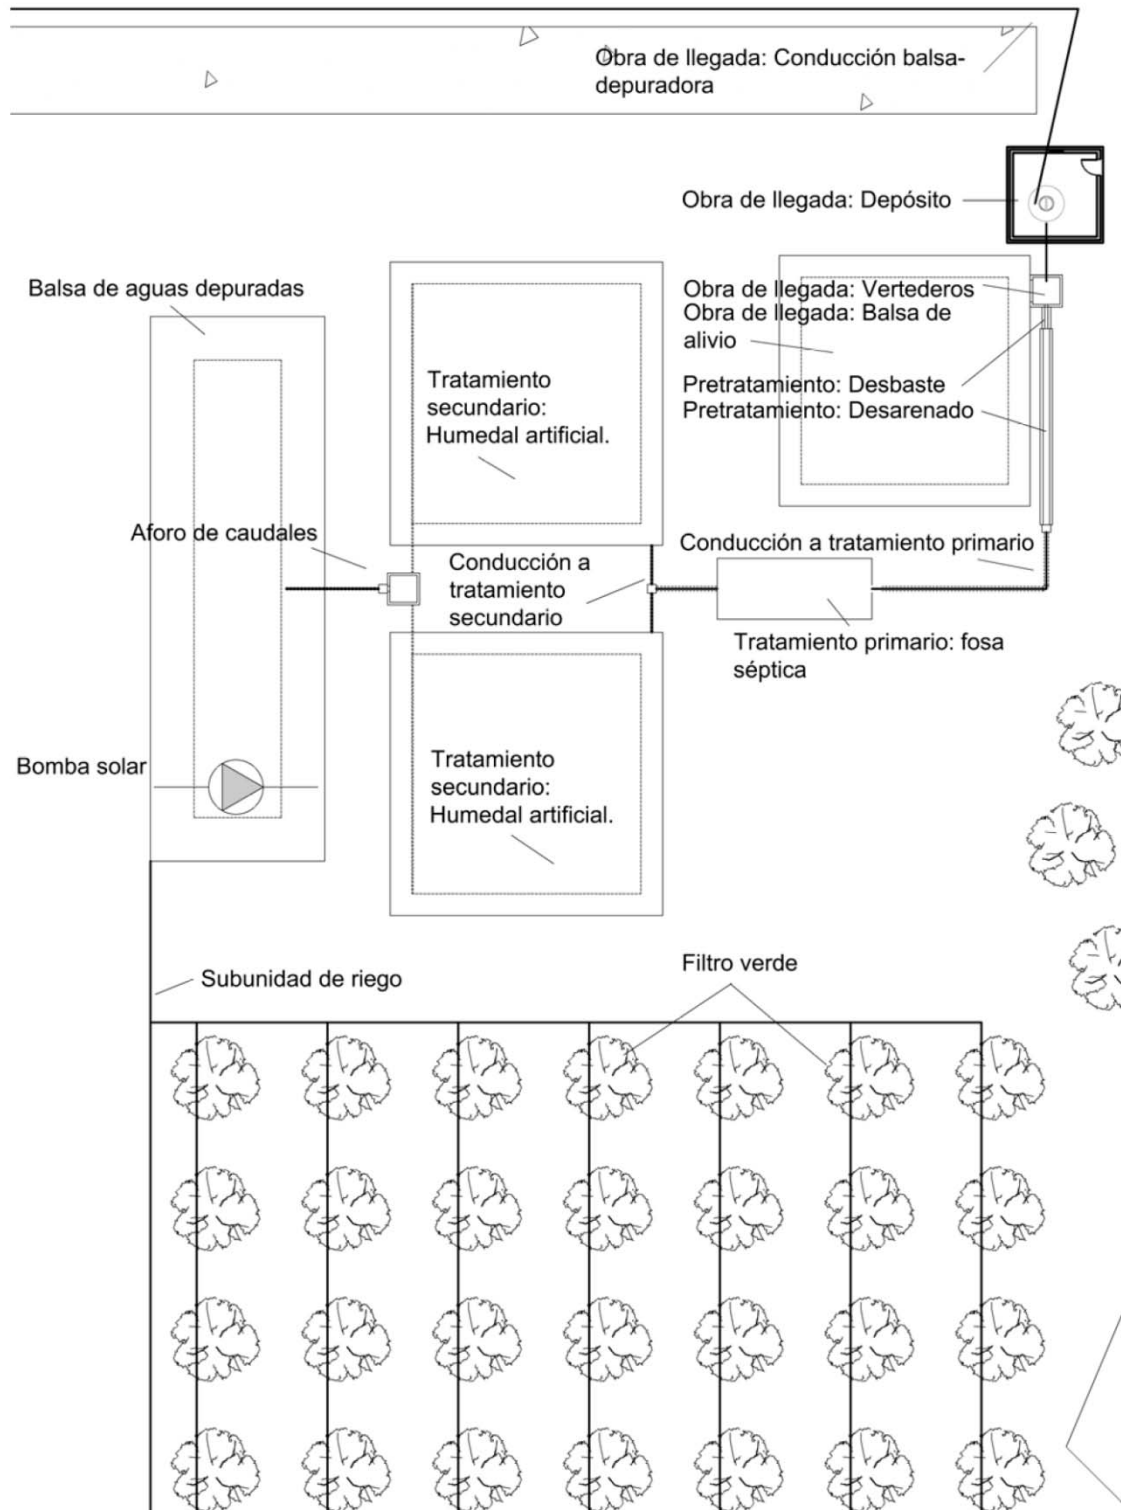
Planta simplificada del proyecto en la que se señalan las principales fases y los elementos relevantes para el anejo de dimensionado y cálculo hidráulico. Fuente: elaboración propia.
